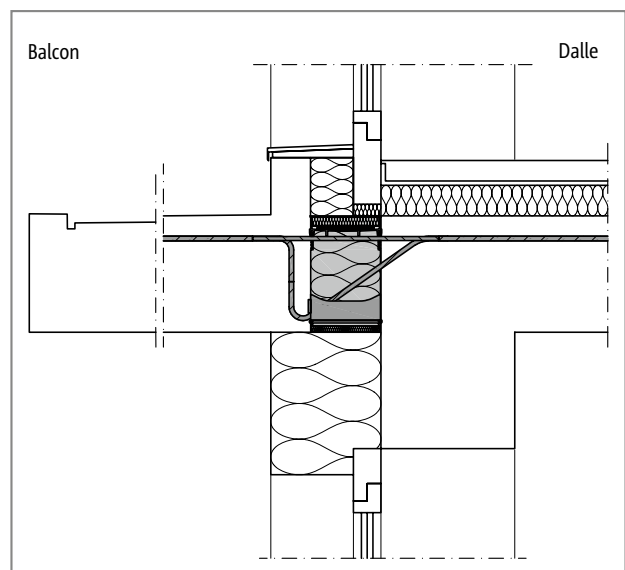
Schöck Isokorb® T Type K : Raccordement avec détail de la fenêtre au-dessus et en dessous du raccordement
